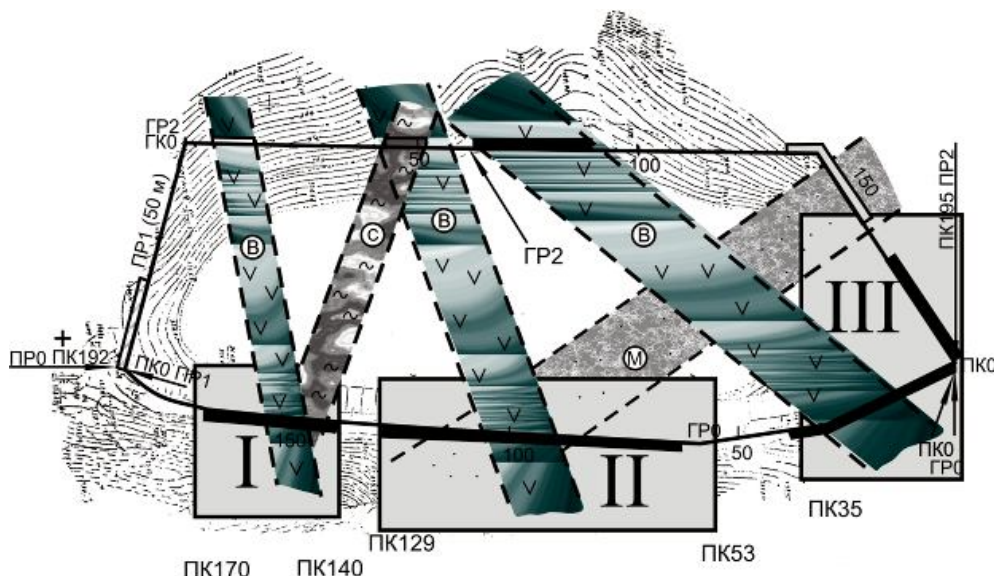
Участки проведения тампонажных работ на водохранилище
